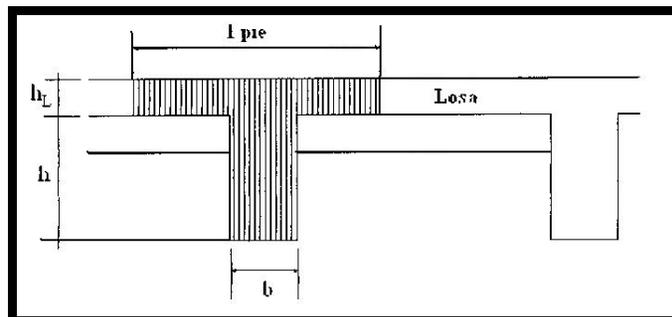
Sección de viga externa y losa para carga muerta.
